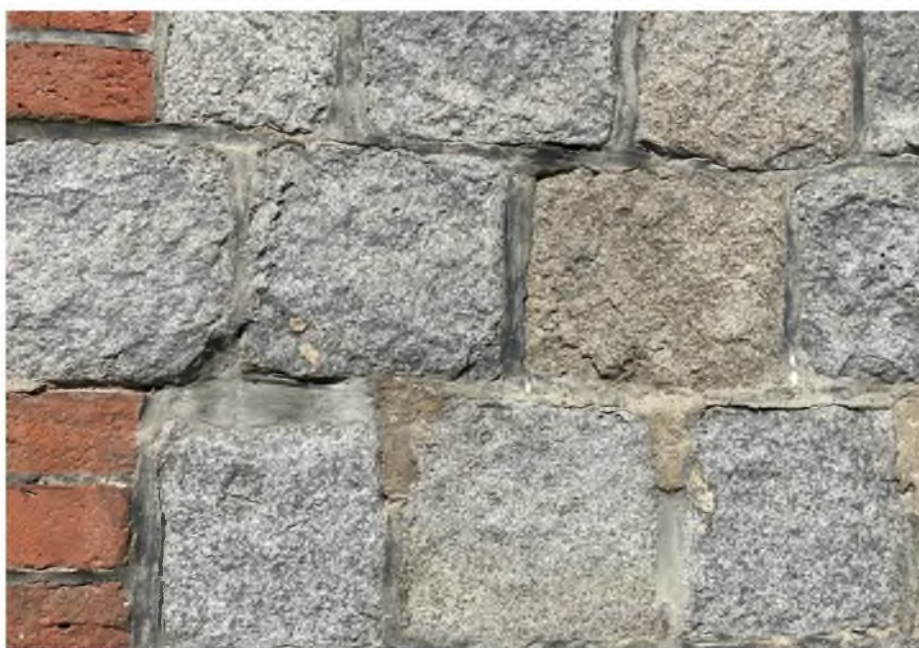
Elewacja wschodnia. Fragment. Zdjęcie wykonała M.Podgórska-Makal
